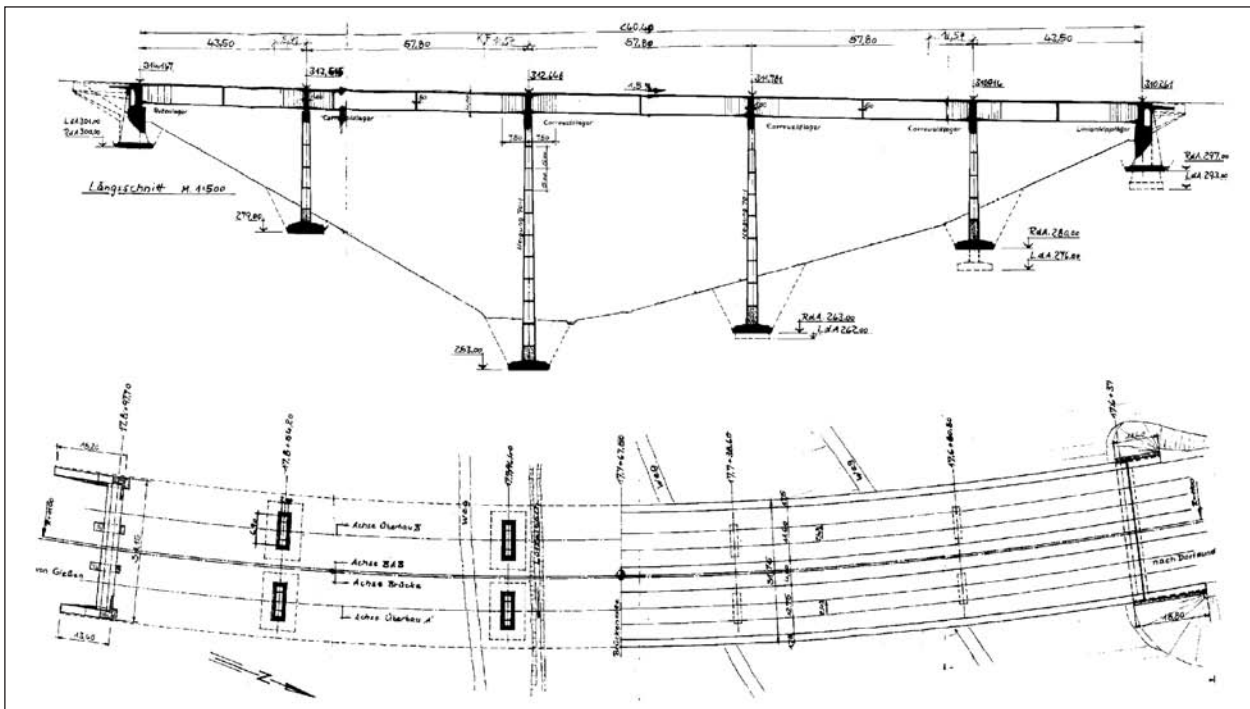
Ansicht und Grundriss der Lützelbachtalbrücke
